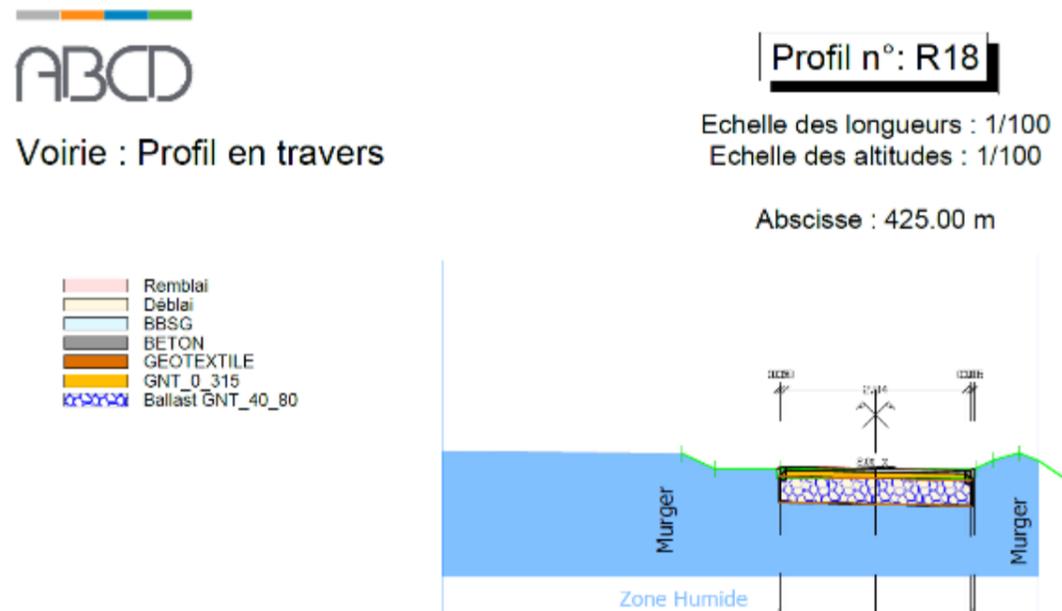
Profil en travers de la voie verte passant entre les murgers (Section 2-9) (Source : ABCD-experts)
